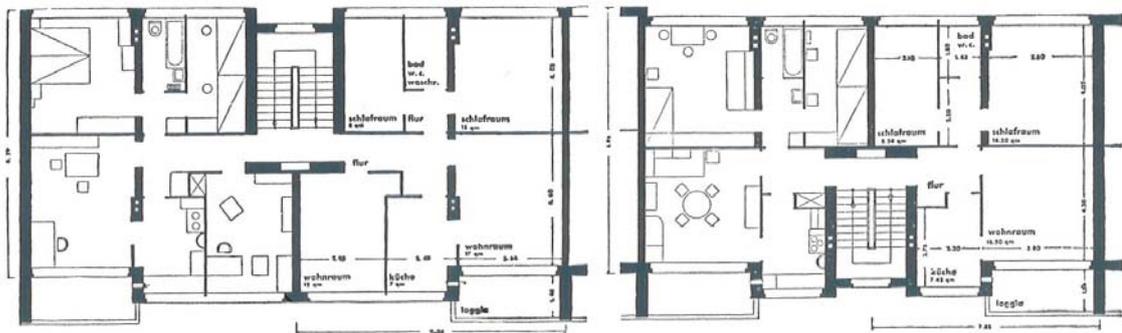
Typengrundrisse einer 2,5 und 3,5 Zimmerwohnung, Dammerstock
